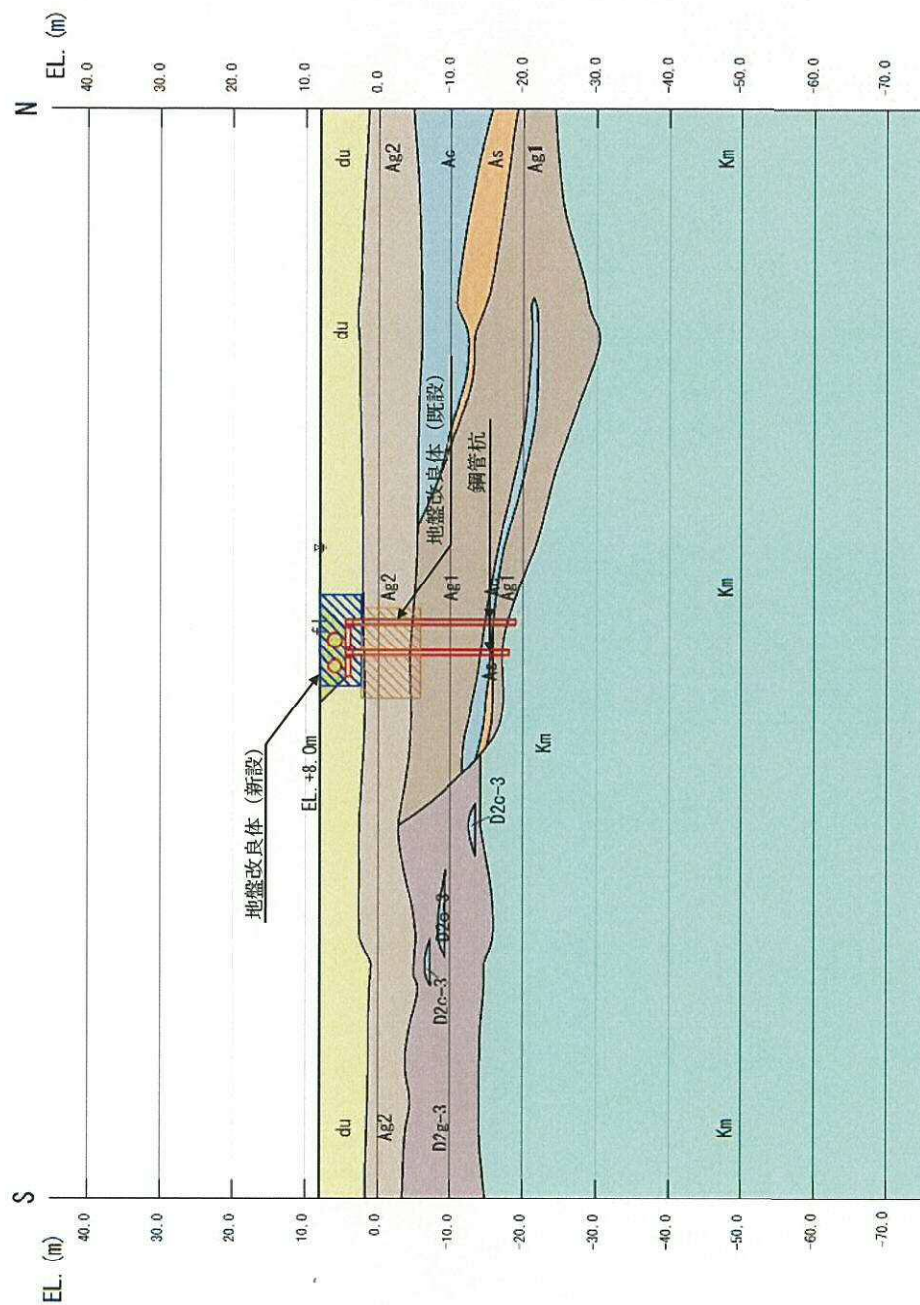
4. 3-15 (3) 屋外二重管の横断面図 (C-C 断面・杭基礎構造部) (区間Ⅱ 候補断面⑥-1)
